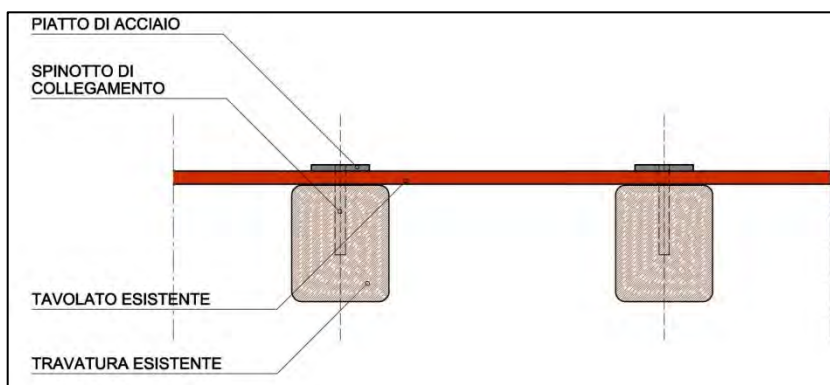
Sezione trasversale solaio consolidato con profili metallici
